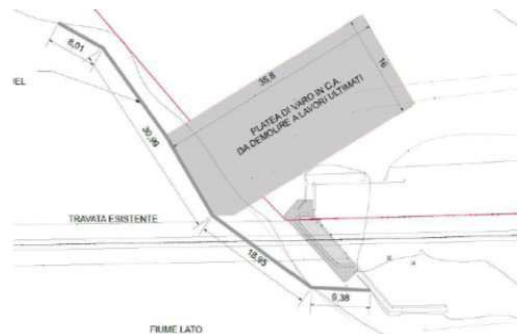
Struttura anti-erosione lato spalla Metaponto - Pianta
